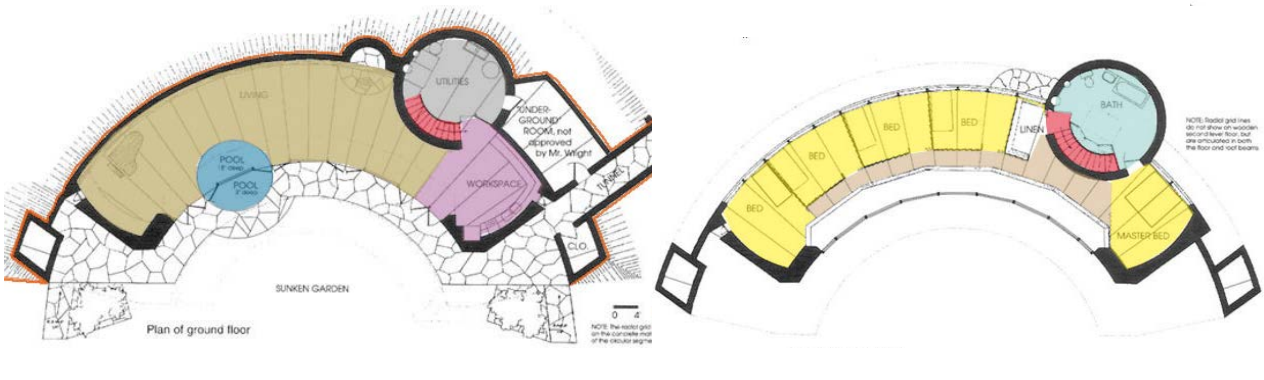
Rez-de-chaussée et premier étage. (6)
